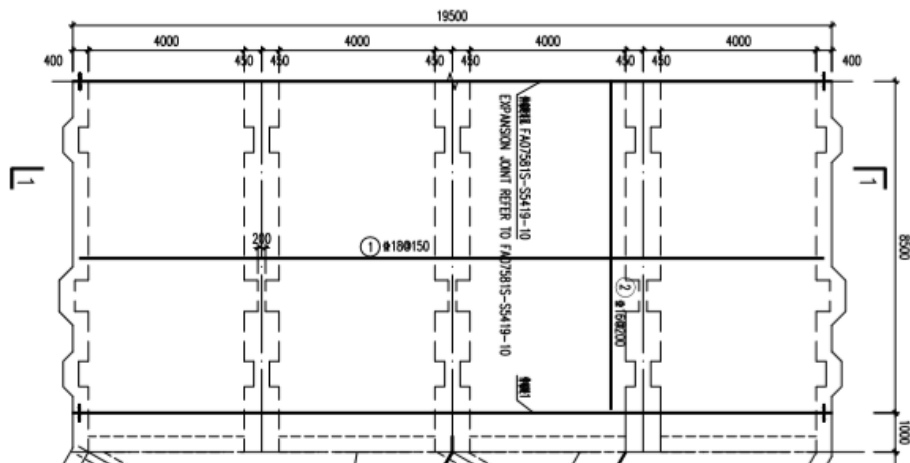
Planta do Troço-A da CCC do Soyo.
